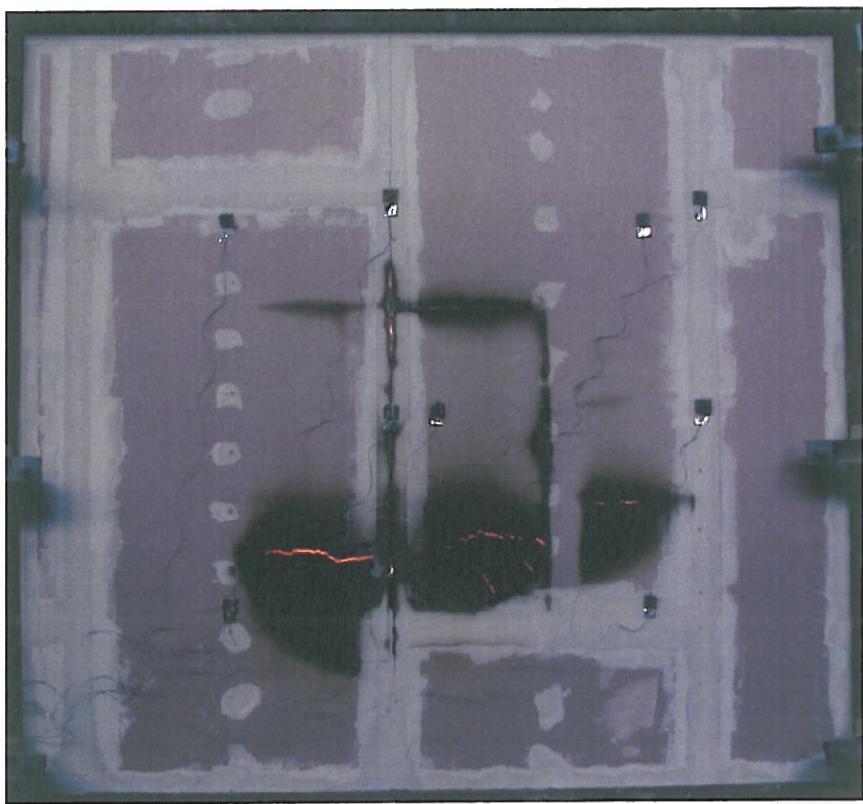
Образец № 1 перегородки типа С 112 с обшивками из ГКЛО
